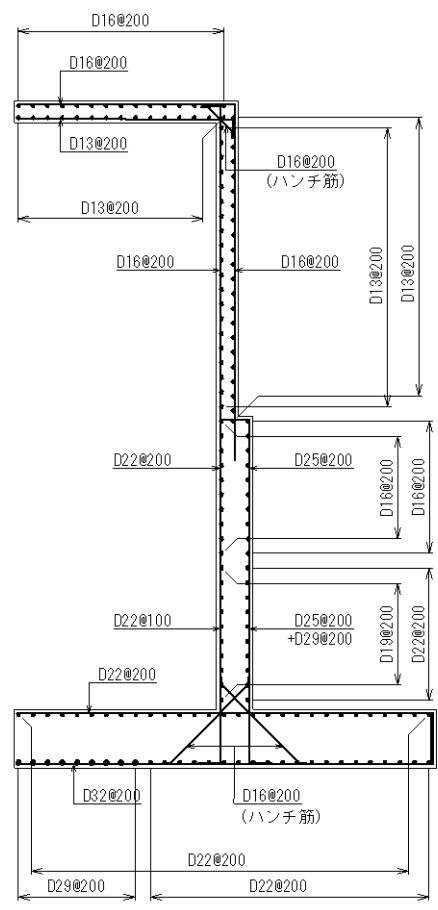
(2) 復水貯蔵タンク遮蔽壁 概略配筋図 (基礎)
